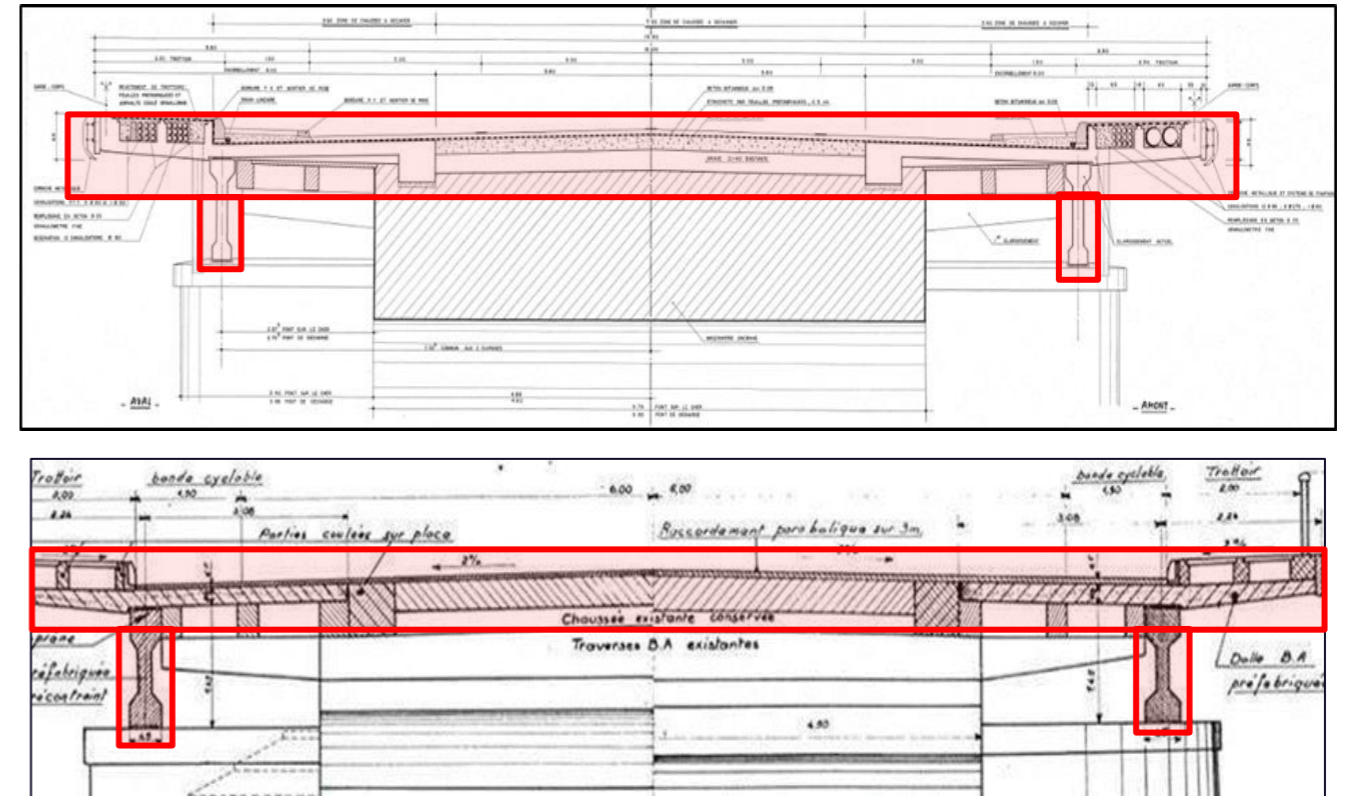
structure béton à démolir (en rouge) sur les ouvrages OA3 (haut) et OA4 (bas)
